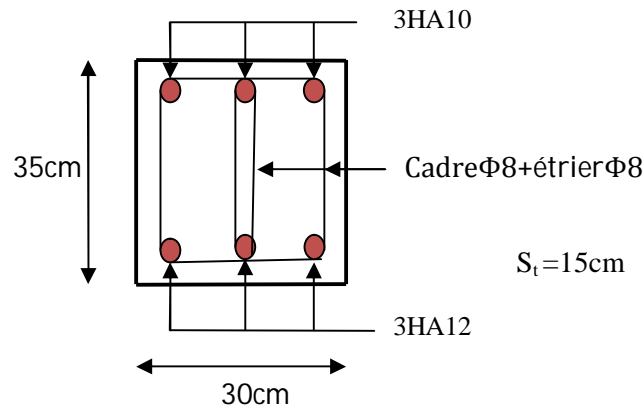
schéma de ferrailage de la poutre de chaînage
